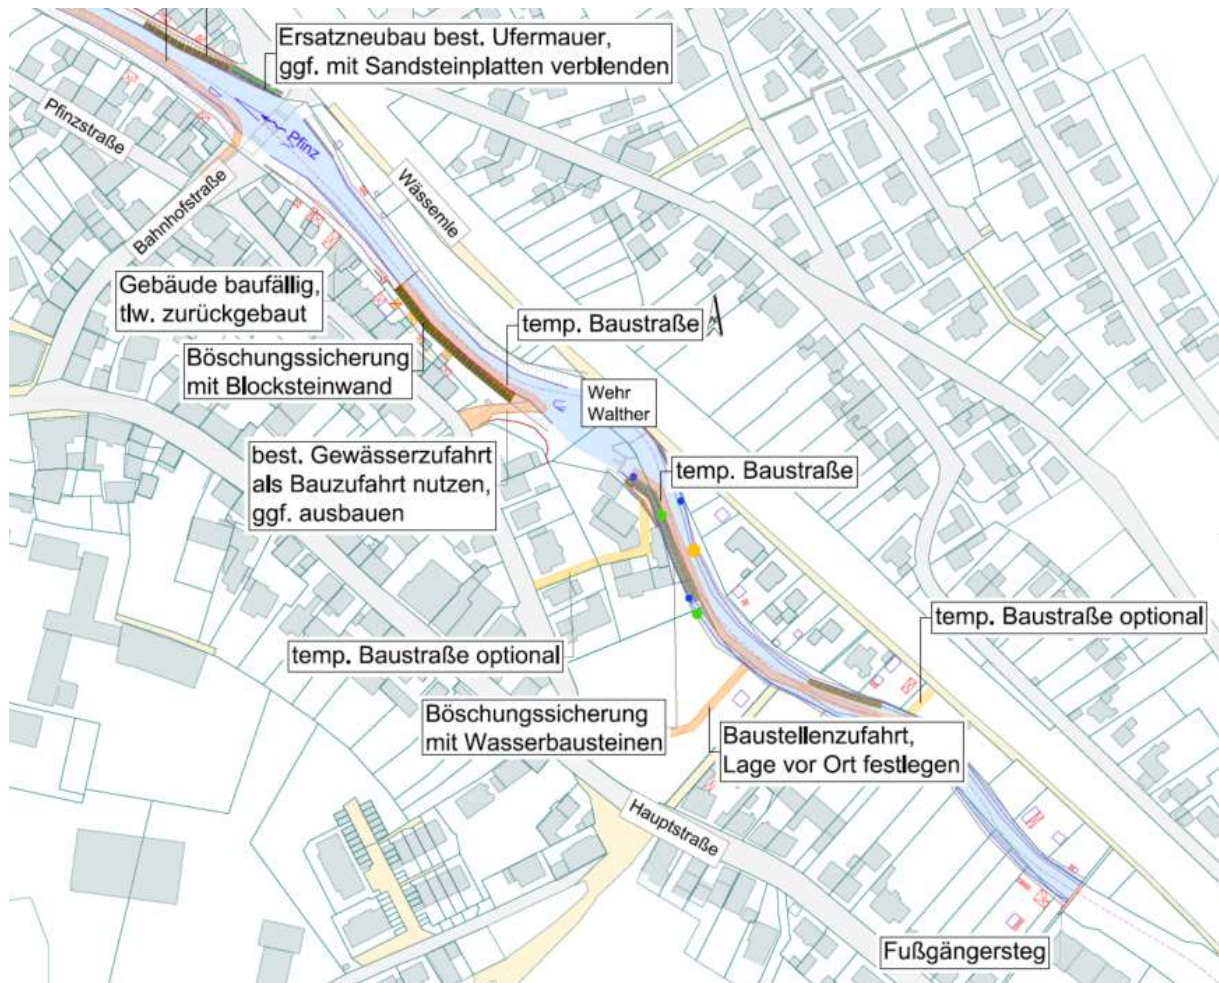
Bauabschnitt 2, Bereich oberstrom der Bahnhofstraße, Lageplan
